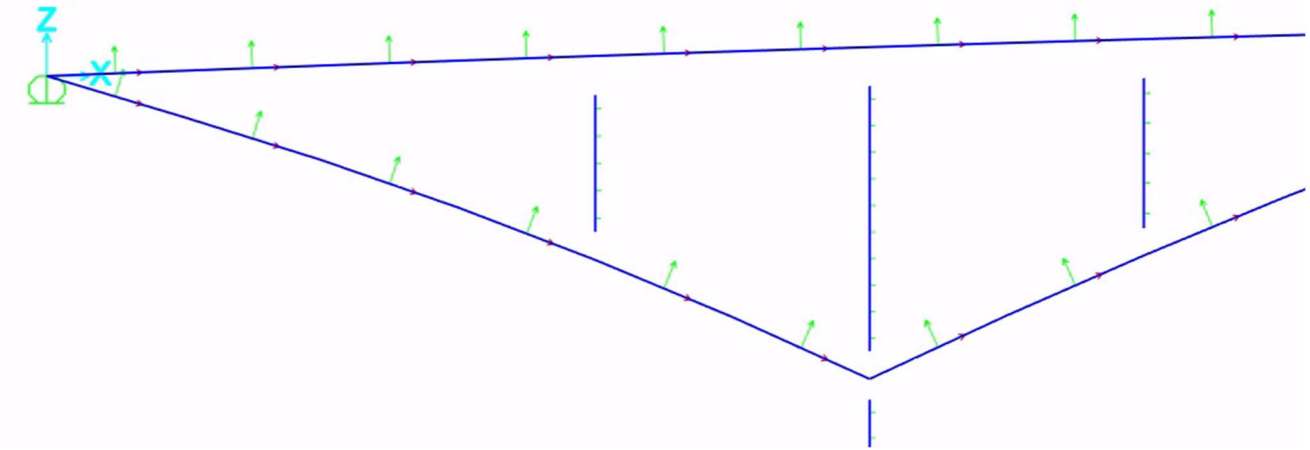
Vista XZ de una parte del puente, con los ejes locales de los elementos (fuente: elaboración propia)
